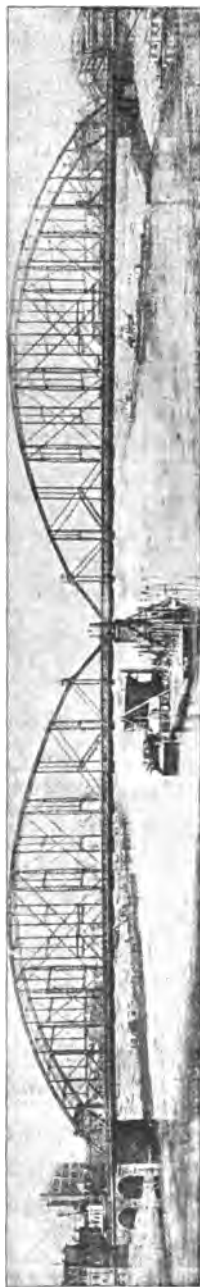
Pont de la Sixième Rue. (Deux travées de 133^m, 97). — (Rail Road Gazette).
